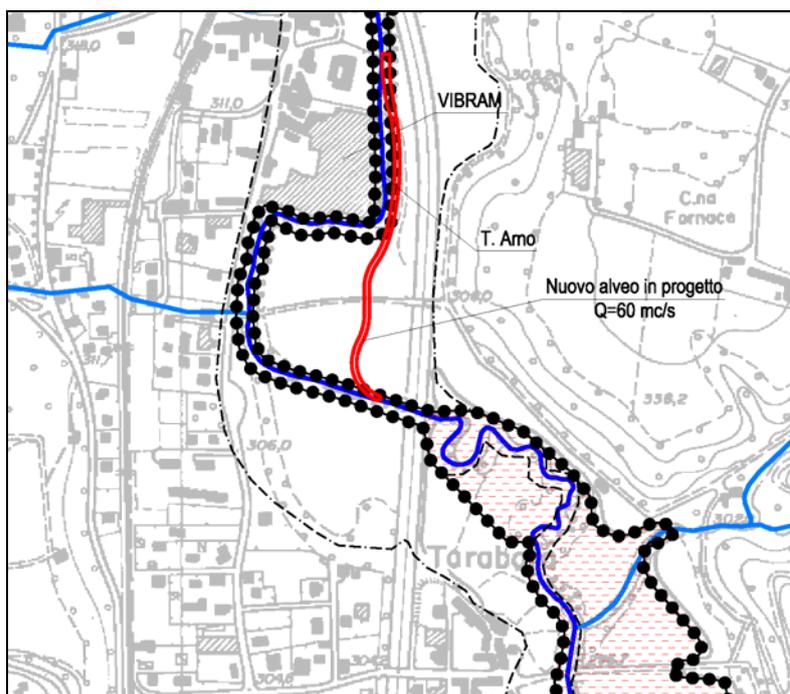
Planimetria con indicazione delle fasce PAI attuali e, in rosso, il nuovo inalveamento proposto.
